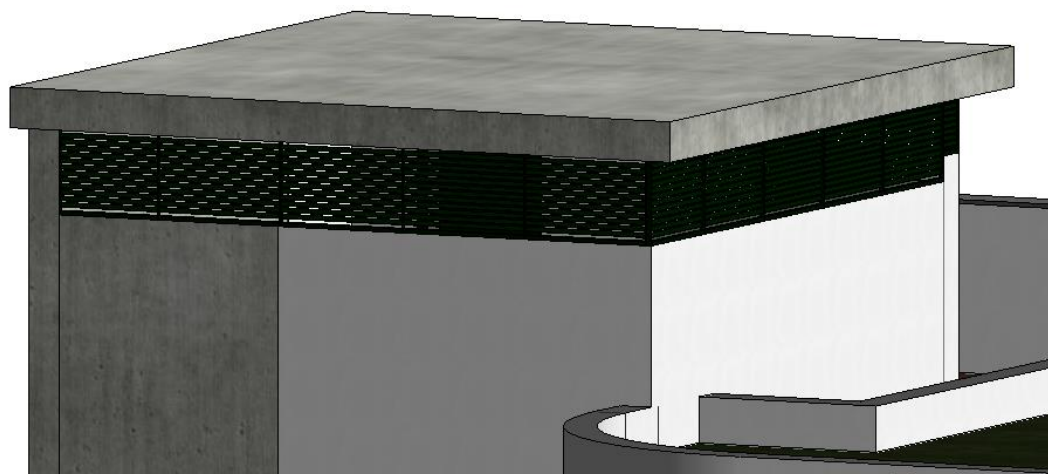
Grelhas metálicas quinadas na caixa de máquinas do elevador
